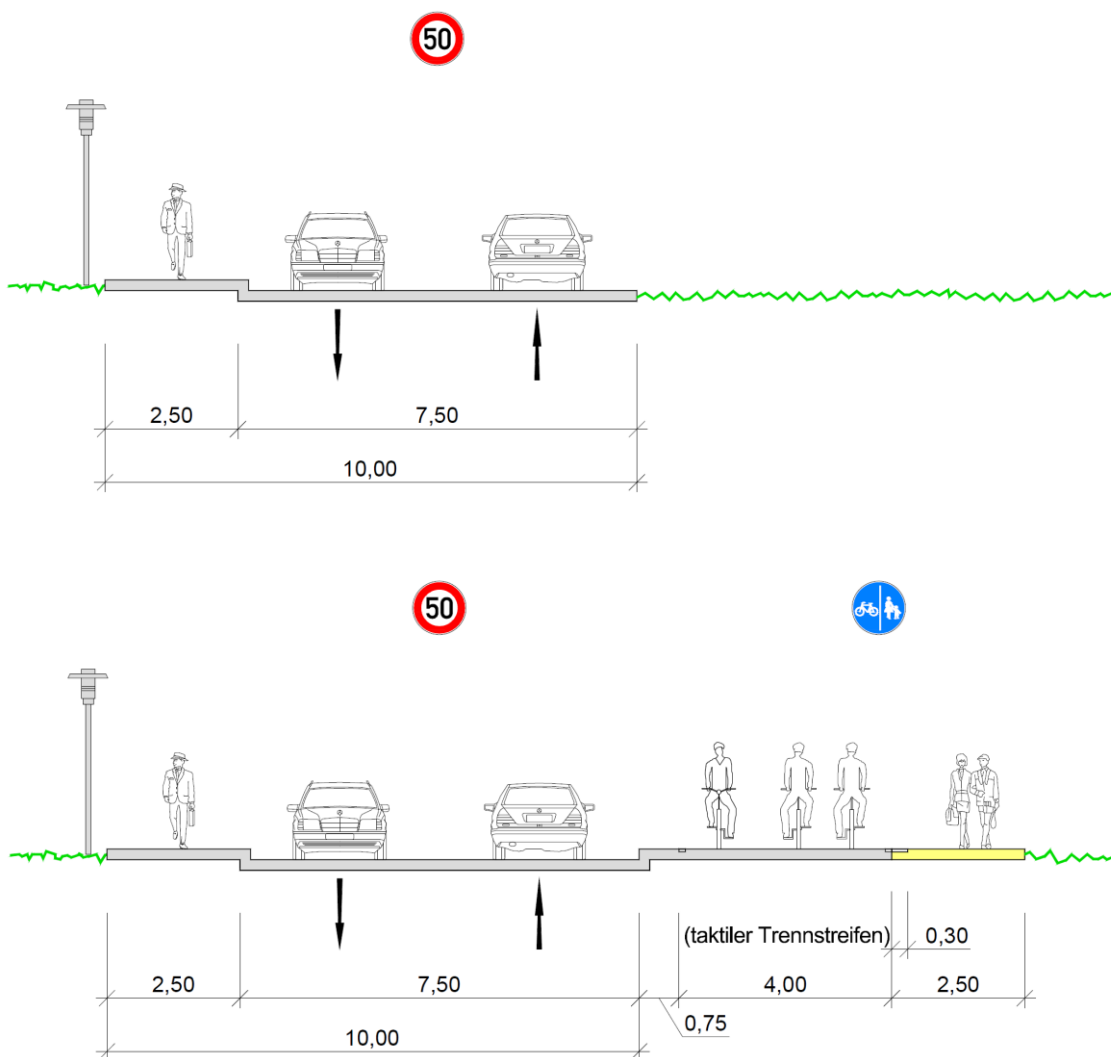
Zeppelinstraße/Dieselstraße (Schleißheimer Straße bis Schafweideweg) – Bestand (oben) und Planung (unten)
